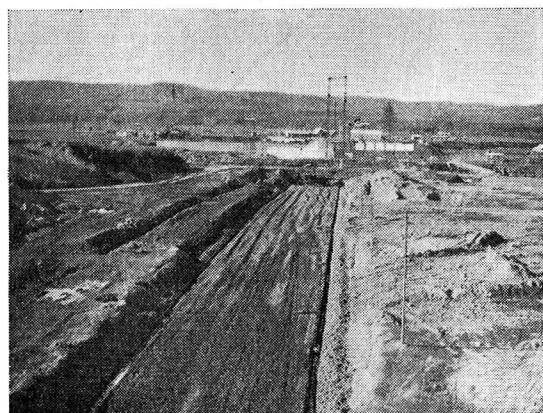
仙美里ダム非越流部のアースダム全景 36.11.13
